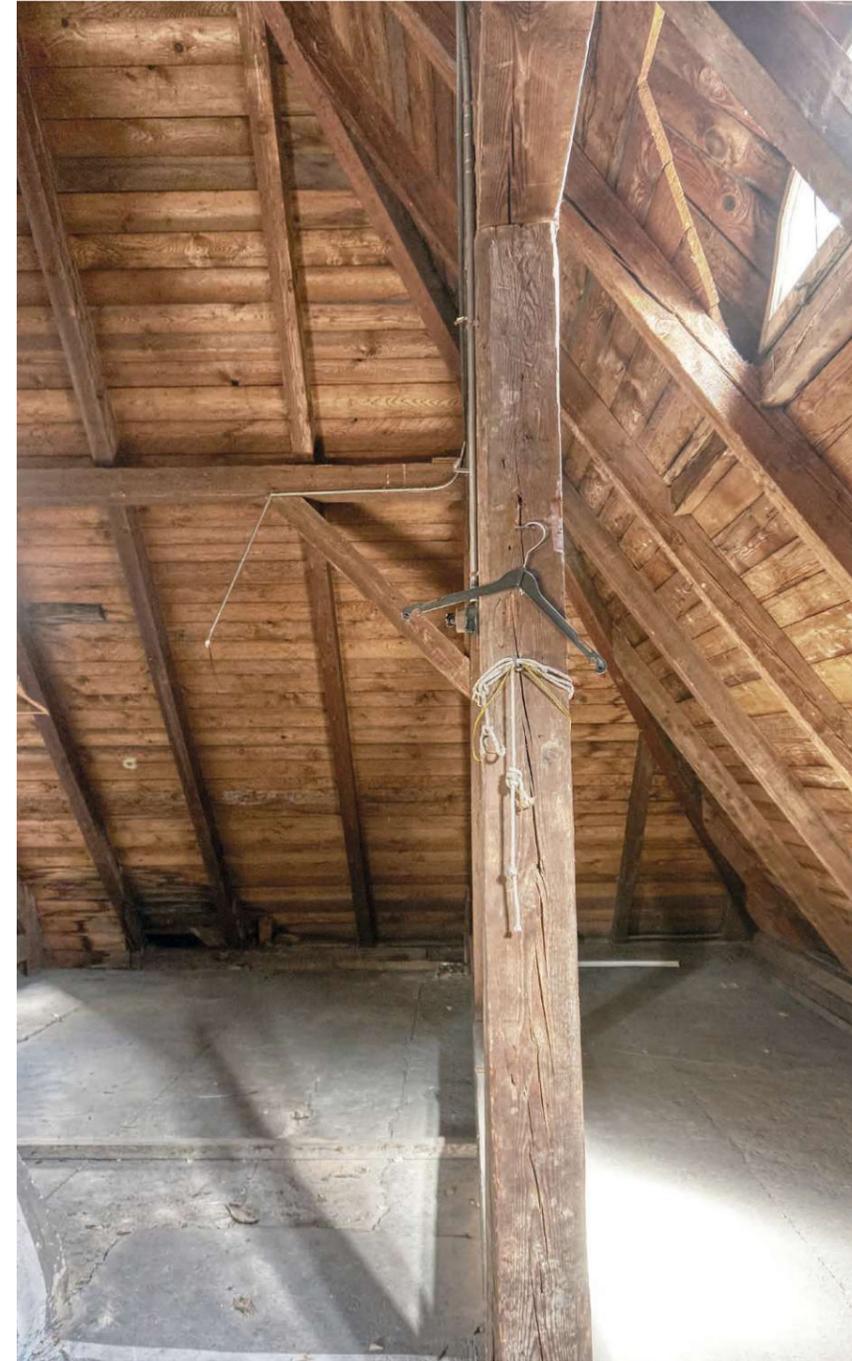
Dachkonstruktion, Spitzboden – Raumbuch.
